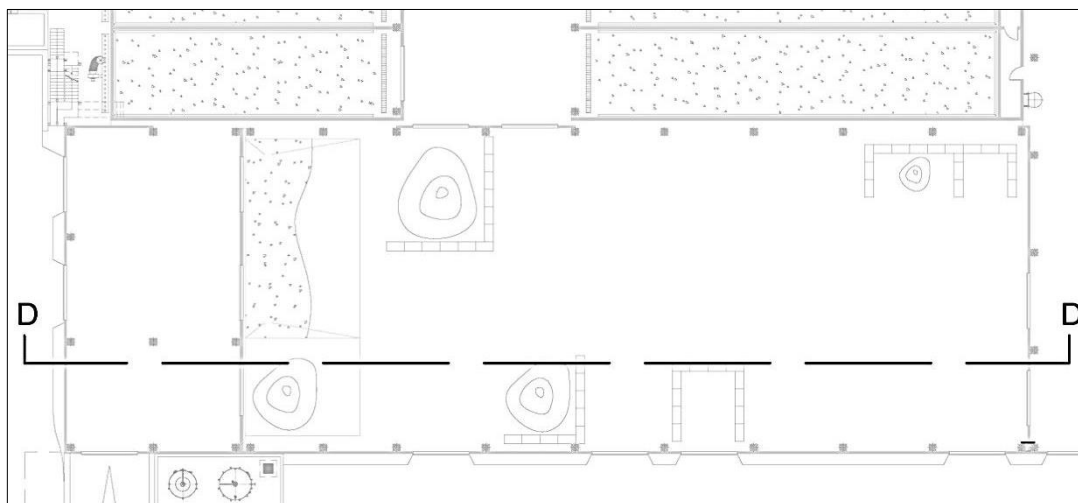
PLANIMETRIA AREA CONFERIMENTO E TRATTAMENTO-RAFFINAZIONE FINALE
